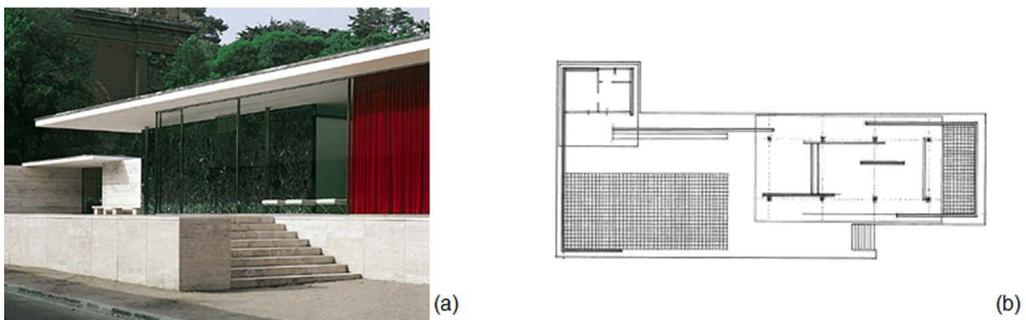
Mies van der Rohe, Pabellón alemán, Barcelona, España, (1929): (a) Vista exterior, (b) Planta arquitectónica.
